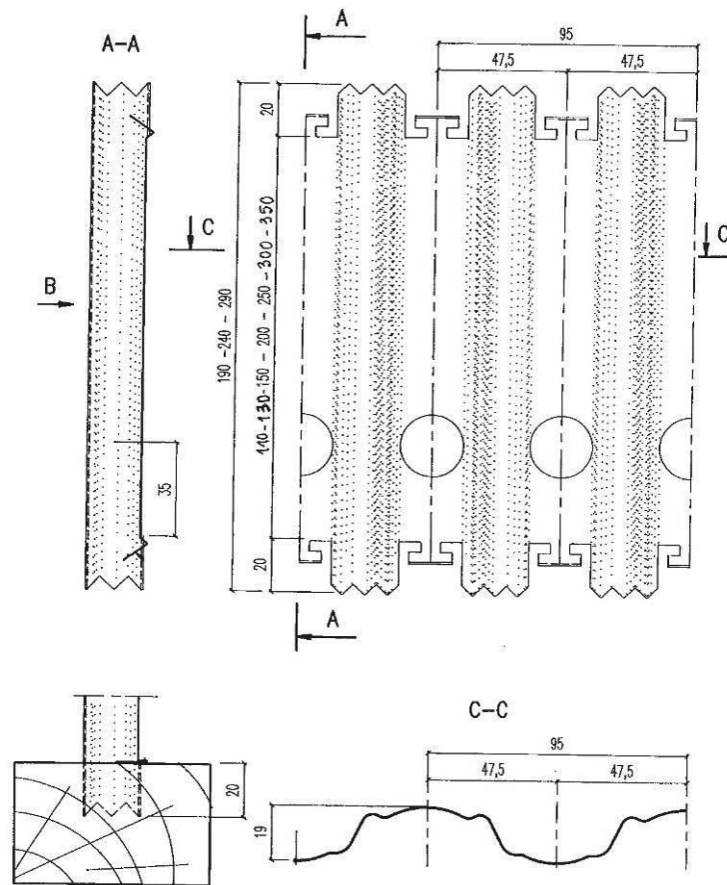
Конструкция стенки балок типа нейл-веб.
